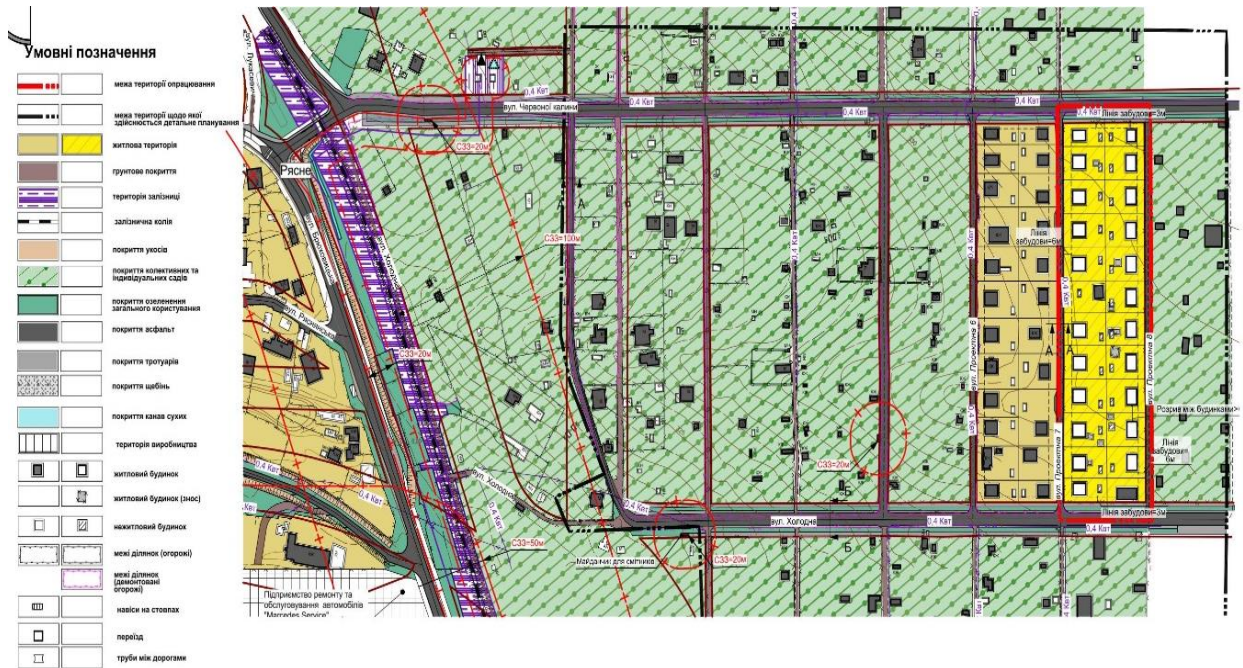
Схема планування території, суміщена із схемою проектних планувальних обмежень для об'єкта дослідження, М 1 : 2 000.
